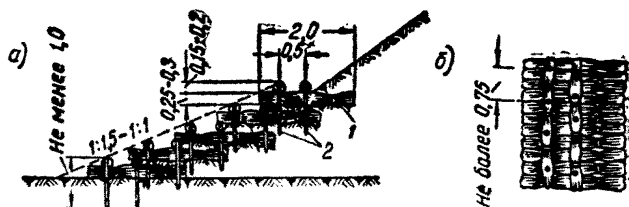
Укрепление откоса насыпи или бермы кладкой легкими фашинами в стенку
